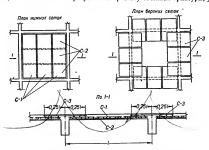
82. Армнрование плит, опертых по контуру, узкими сетками с продольной рабочей арматурой.
